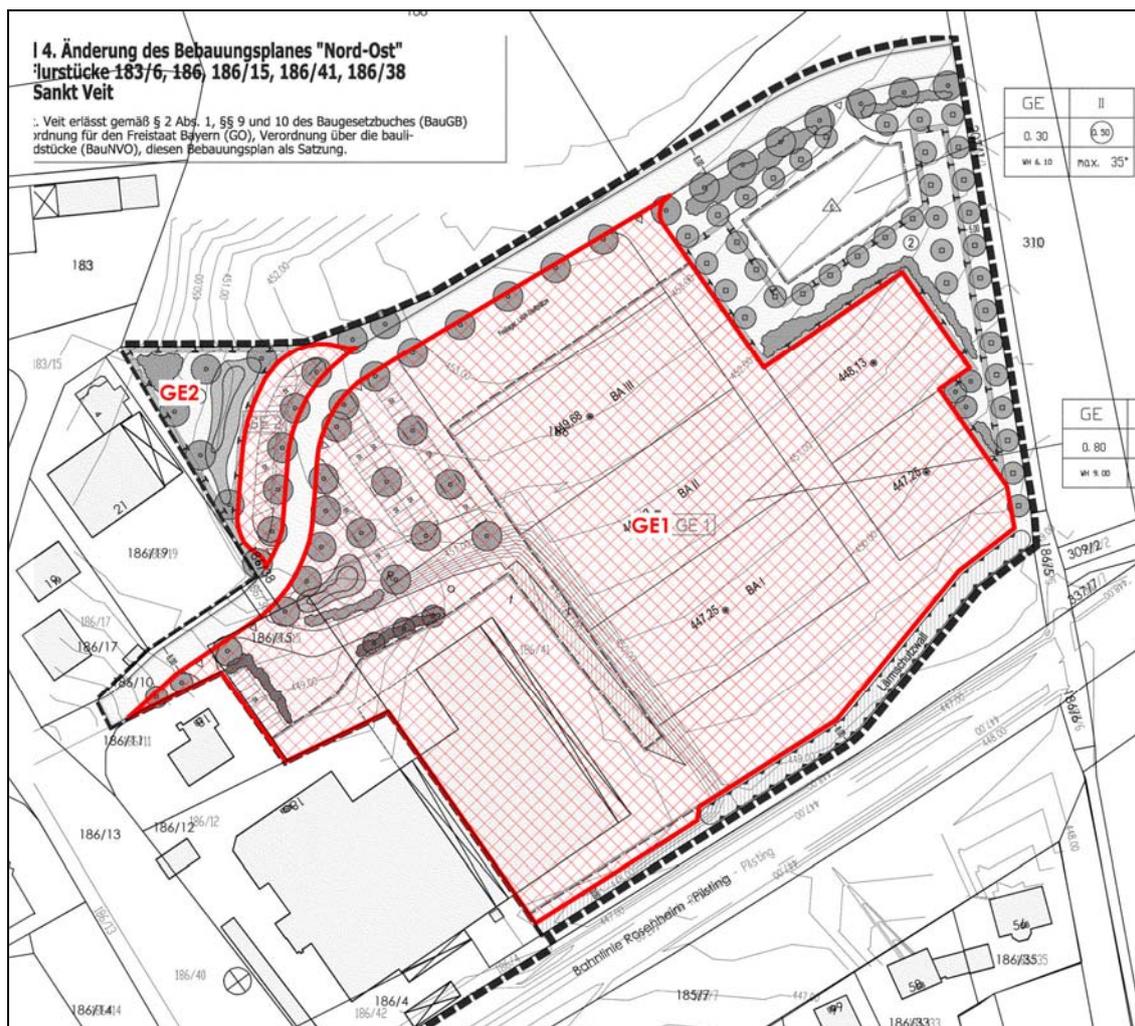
Lageplan mit Eintragung der Teilflächen des Gewerbegebietes
